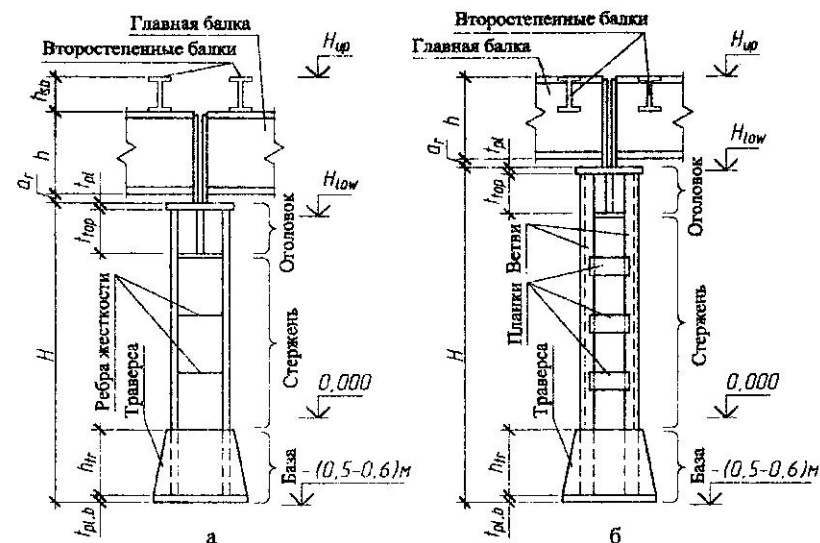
Схемы сопряжения балок между собой и с колонной:
